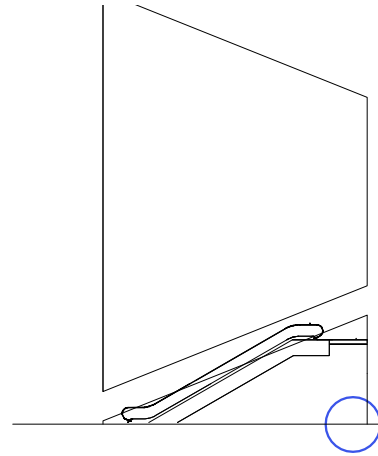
Durchstoßpunkt Kubus - Sahlbetondecke
